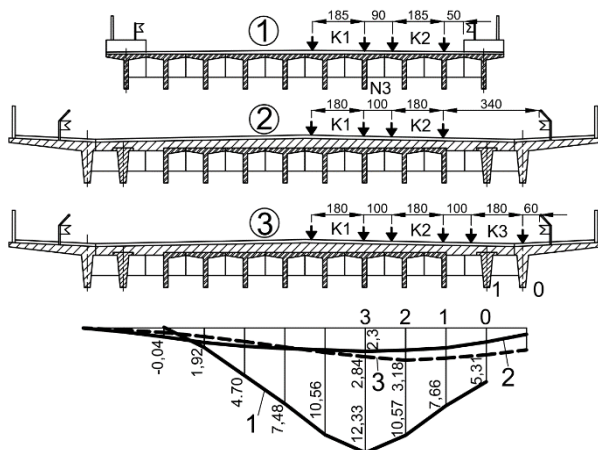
Порівняння прогинів балок за випробуваннями прольотної будови до (1) та після (2, 3) реконструкції
